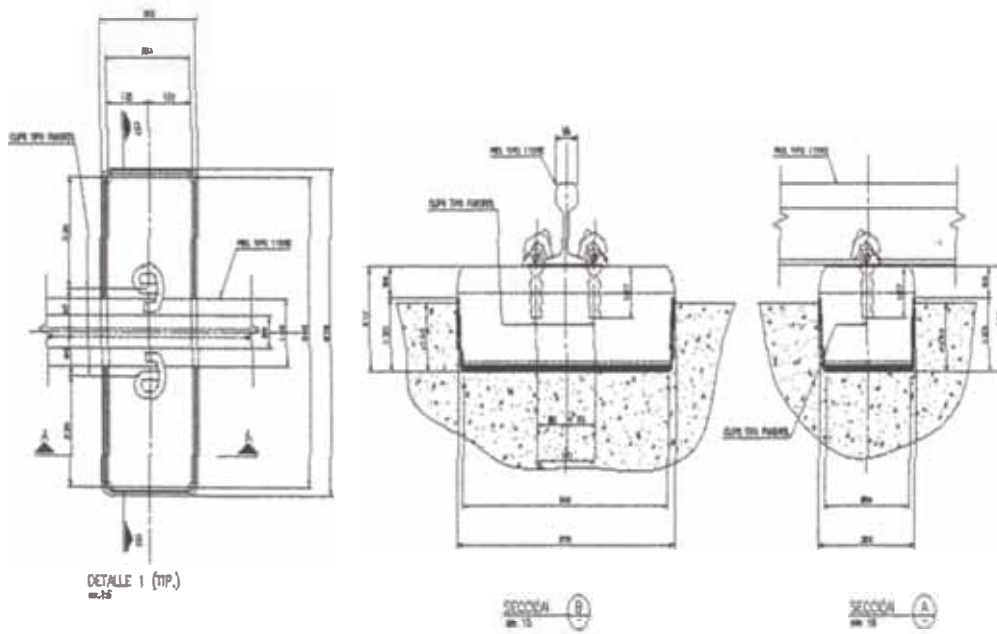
Vista de planta y corte de vía y bloque
